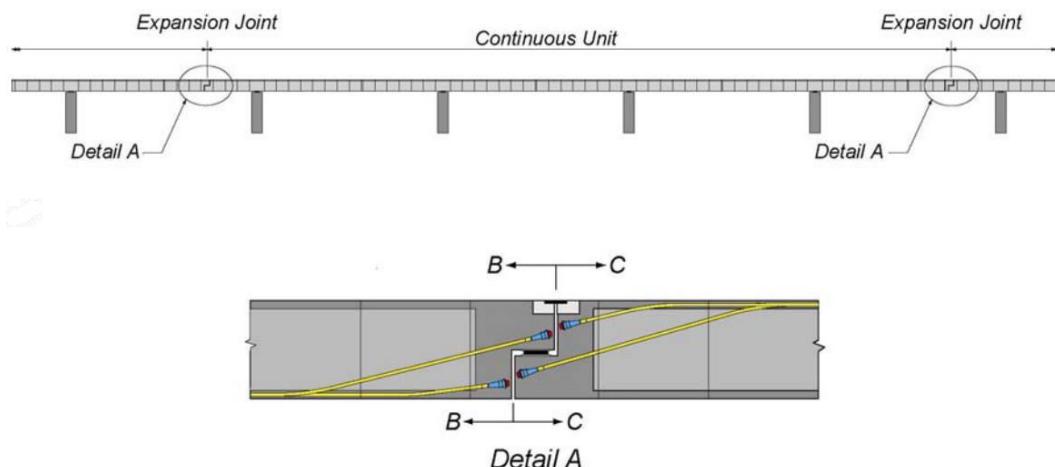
Rótulas en el tramo en la construcción por voladizos balanceados.
